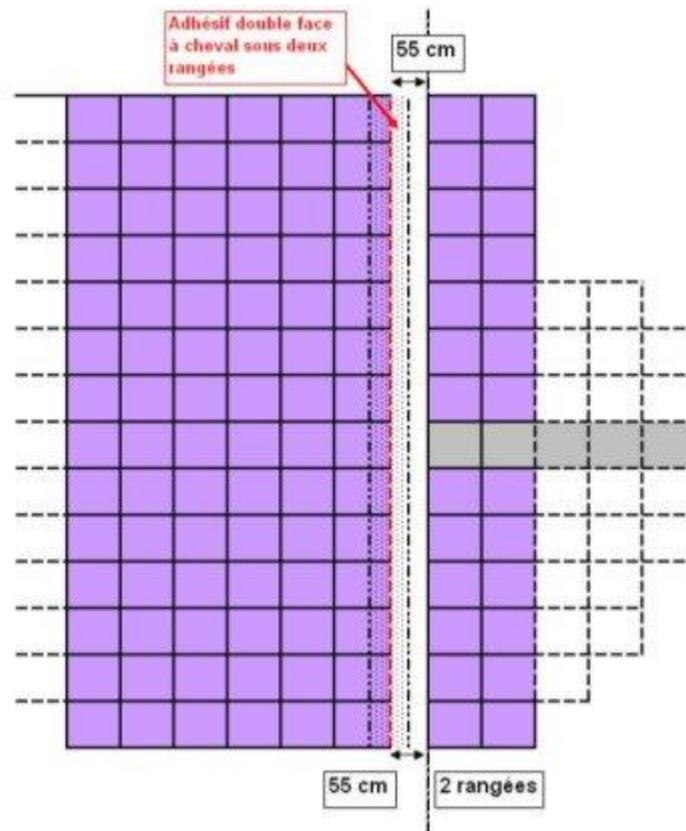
Schéma d'implantation des dalles entre 2 zones de 500m²
